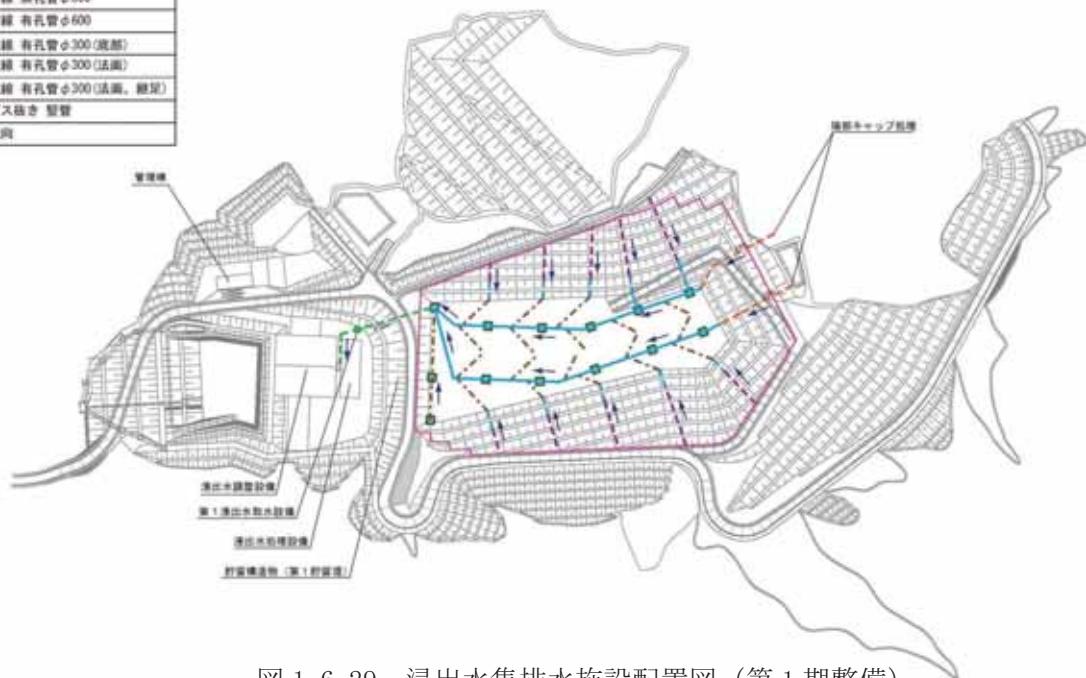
浸出水集排水施設配置図（第1期整備）
